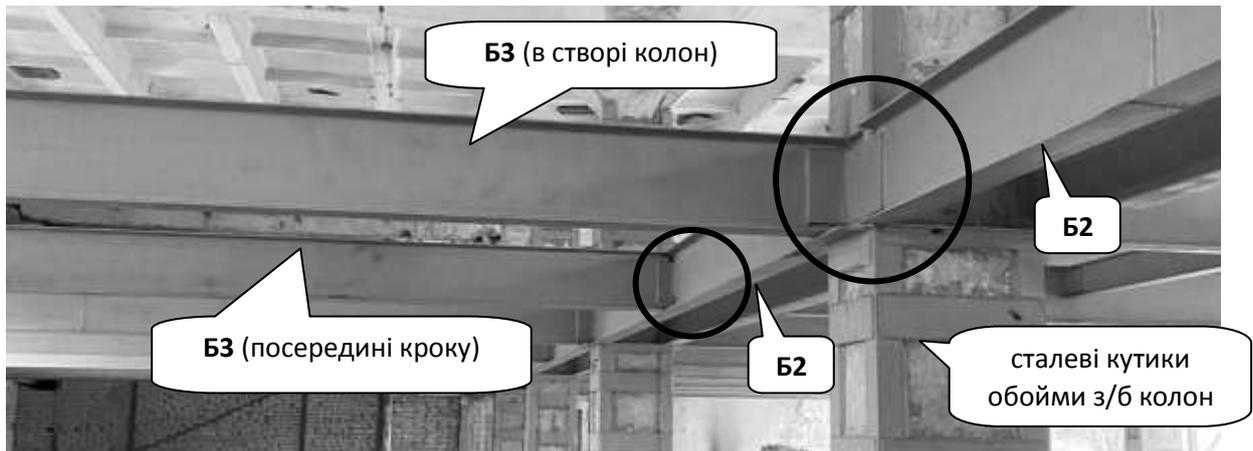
Влаштування опорних вузлів сталевих балок СЗБ перекриття
